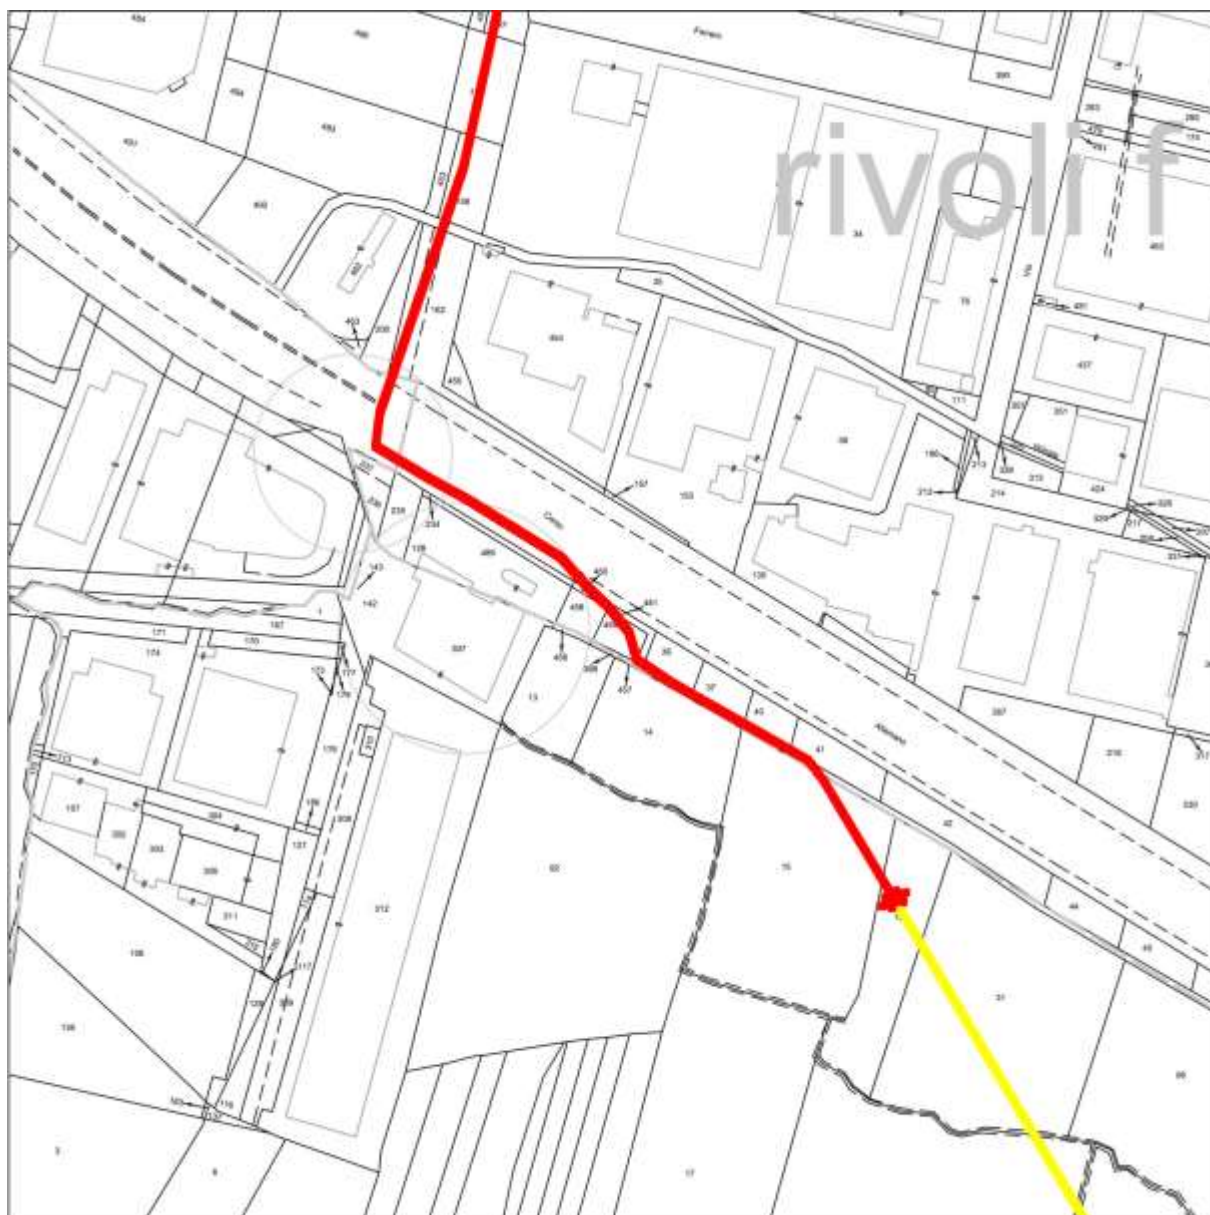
Estratto planimetria Catasto Terreni di Rivoli con sovrapposizione delle opere oggetto di intervento – fuori scala
